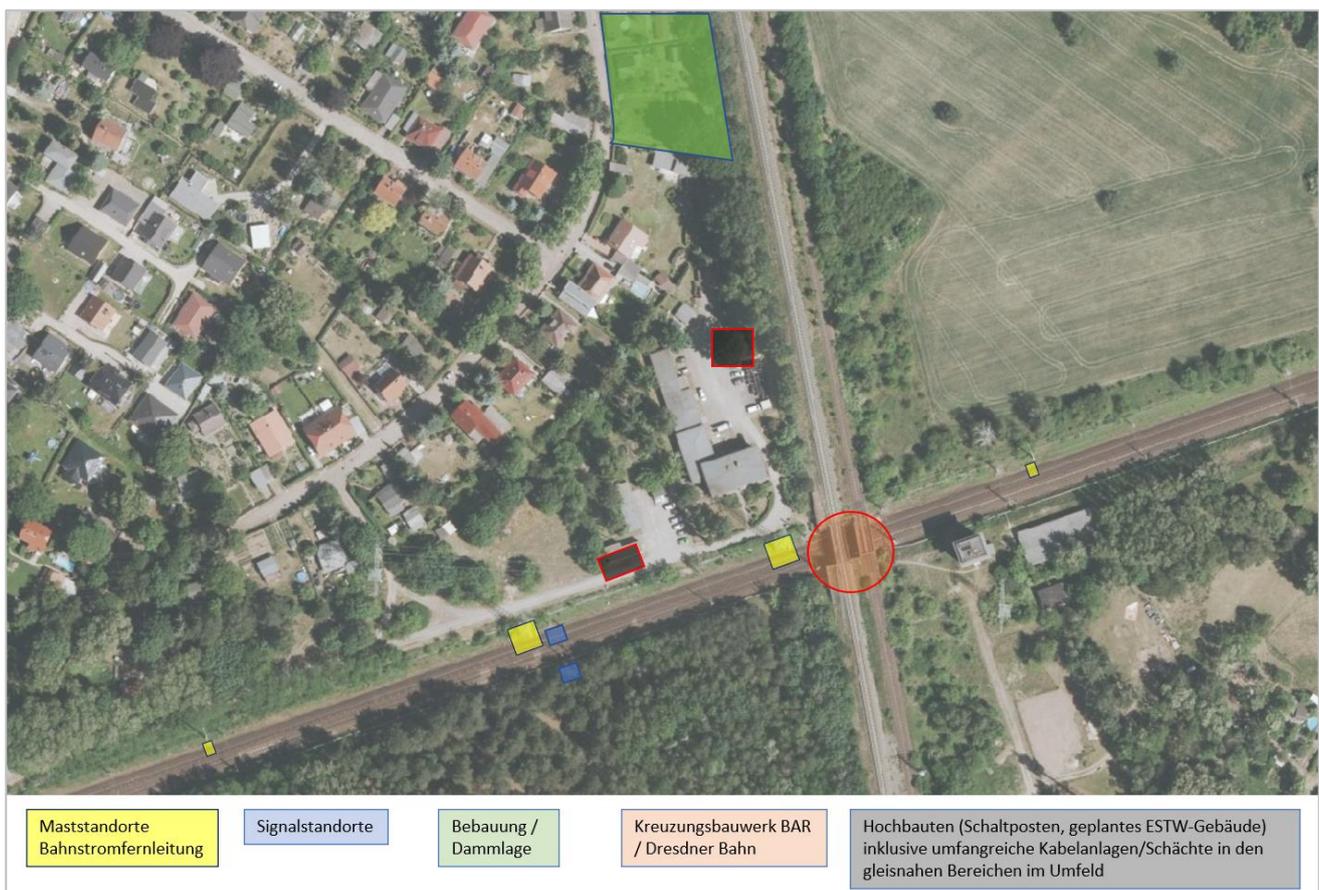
Lageplan Standort A mit den baulichen Zwangspunkten
